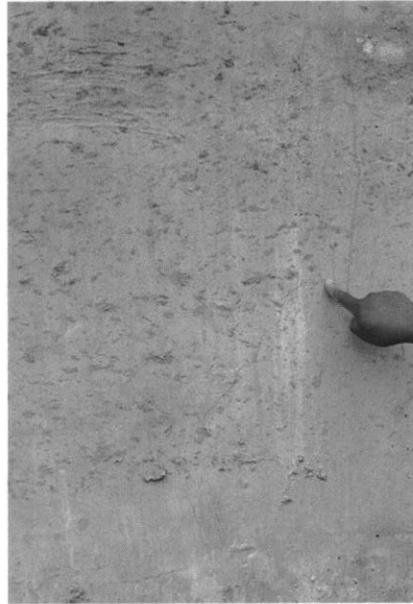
Presencia de fisuras en el tanque Imhoff
